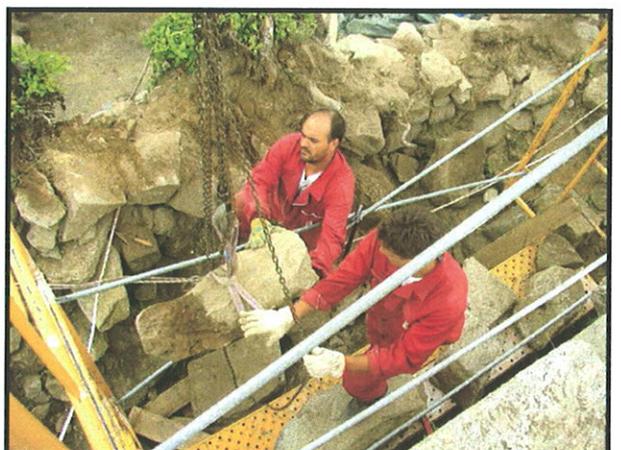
Utilización de eslingas y sinfín para proceder con la retirada de elementos.
